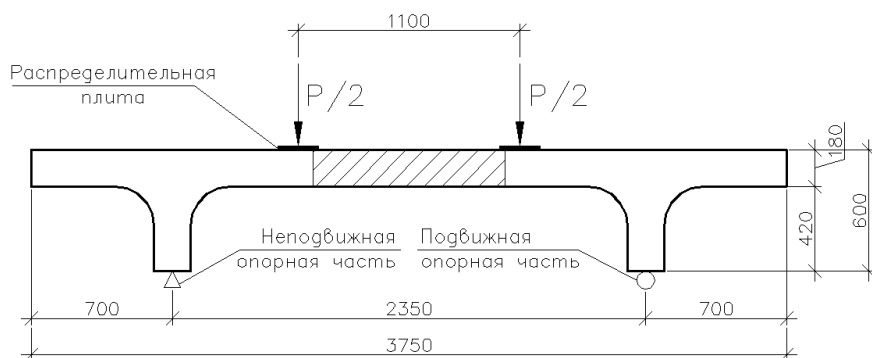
Схема поперечного сечения образца и размещения испытательной нагрузки
